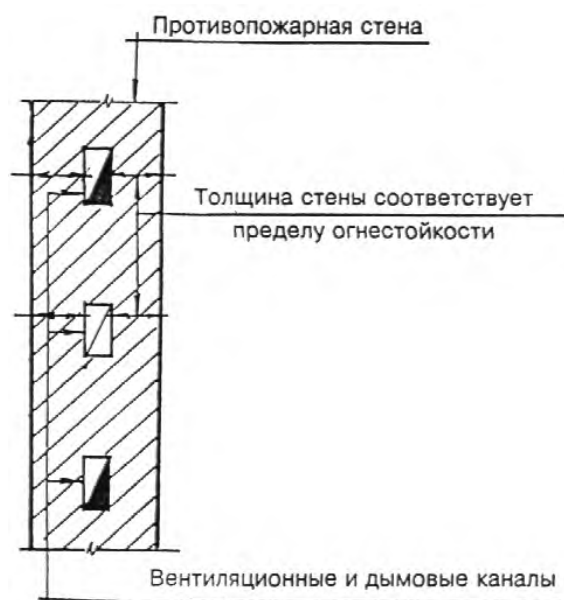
Размещение вентиляционных и дымовых каналов в противопожарных стенах
